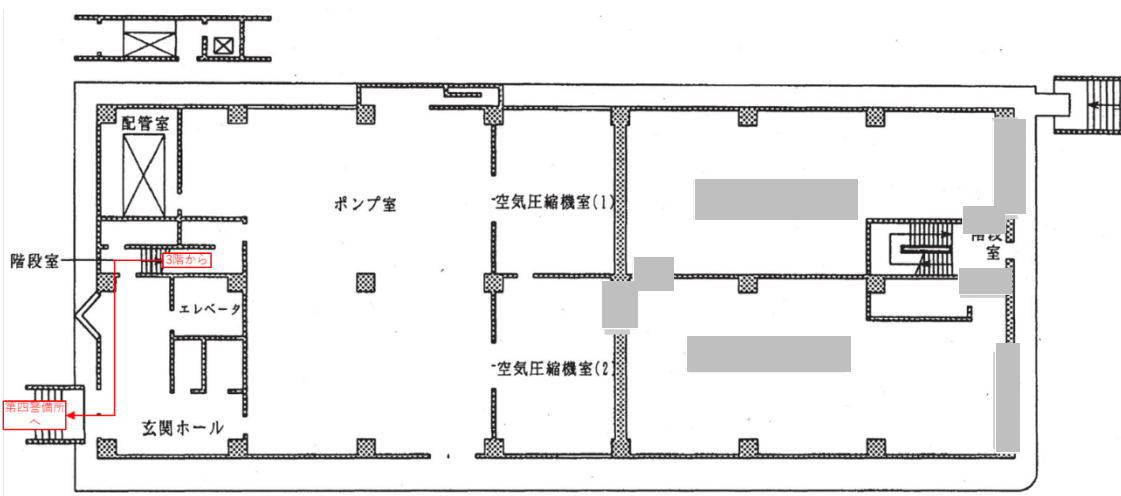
(2) 移動経路 (ユーティリティ施設 地上1F 平面図)
